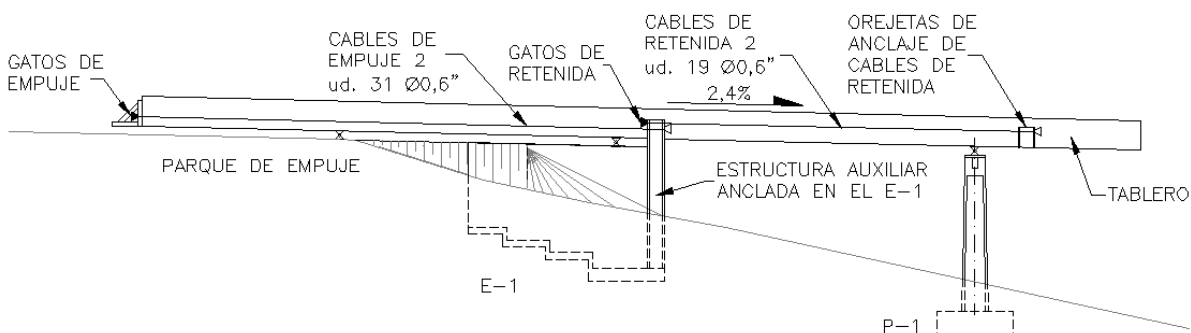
Esquema de cables de empuje y de retenida en el empuje desde el Estribo 1.
